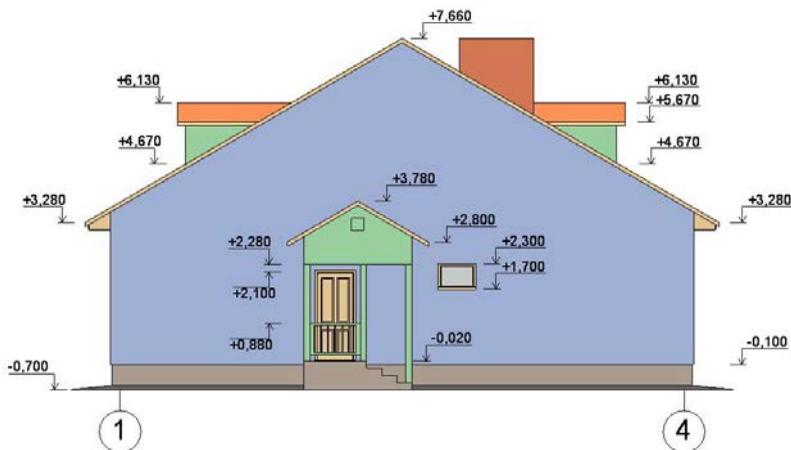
Главный фасад 1–4 (двухскатная крыша)
